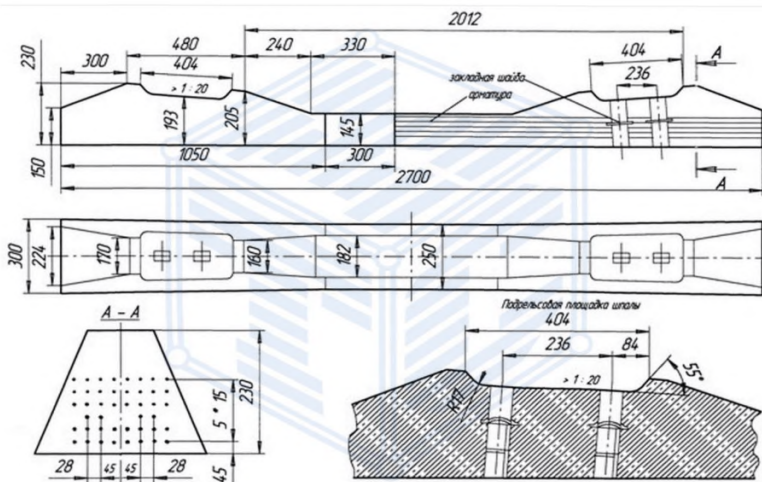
Форма и размеры железобетонной шпалы III-3
